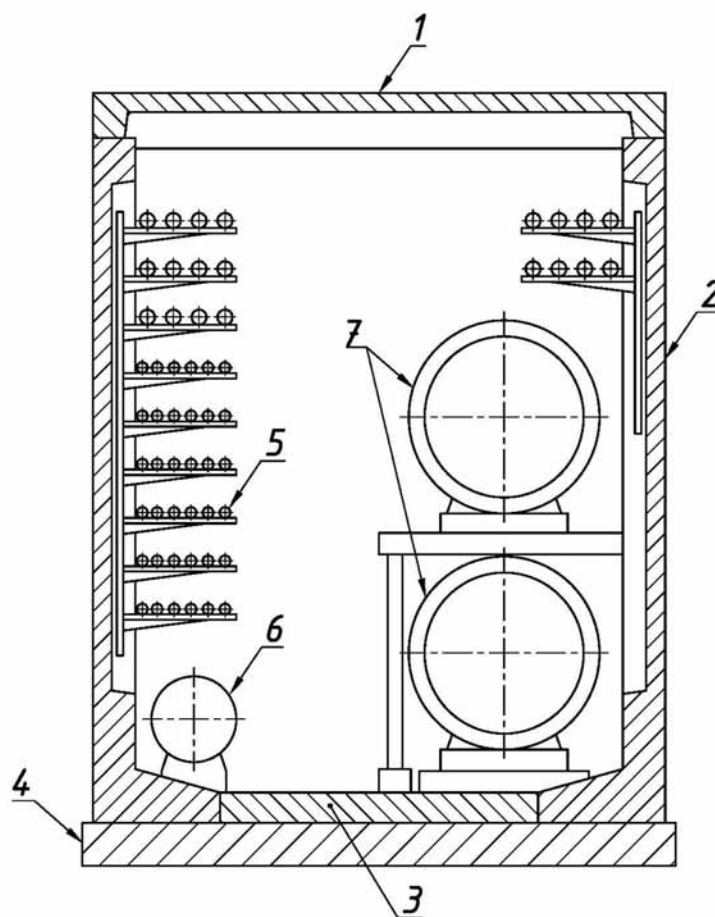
Типовое сечение тоннеля инженерных коммуникаций: 1 – плита перекрытия; 2 – стеновой блок; 3 – блок днаща; 4 – бетонная подготовка; 5 – кабели; 6 – водопровод; 7 – теплопровод
